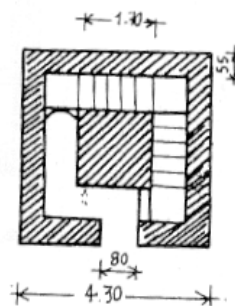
Minaret de Sidi Bou Mediène : plan du Minaret
